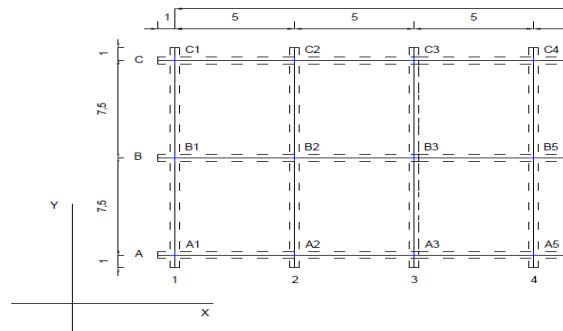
Denah Balok dan Pelat *Trestle
